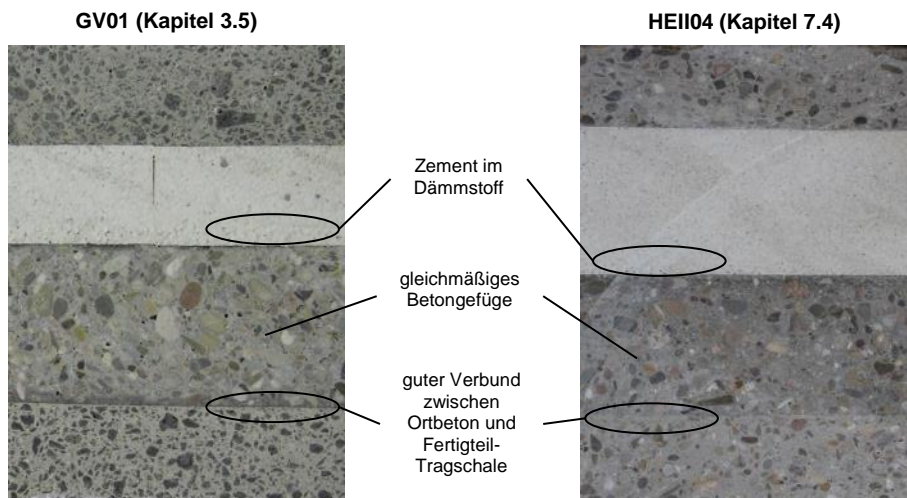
Schnitt durch zwei Elementwände nach Verfüllung der Ortbetonergänzung
